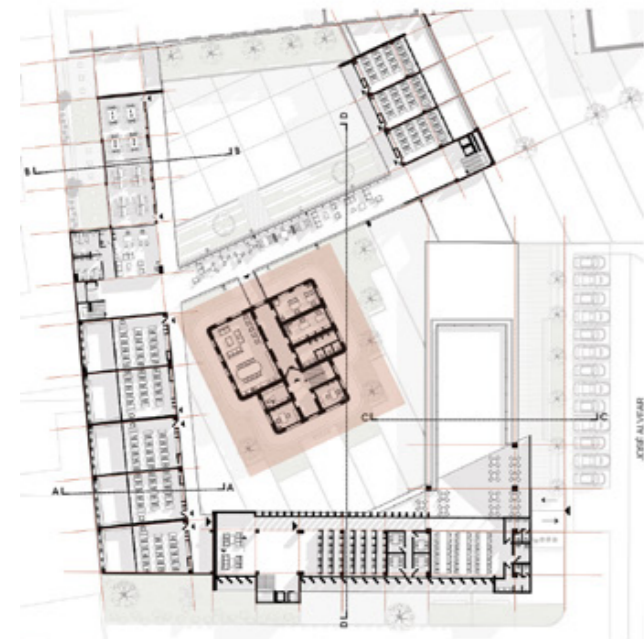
Esquema Planta alta | Fuente: Elaboración propia
